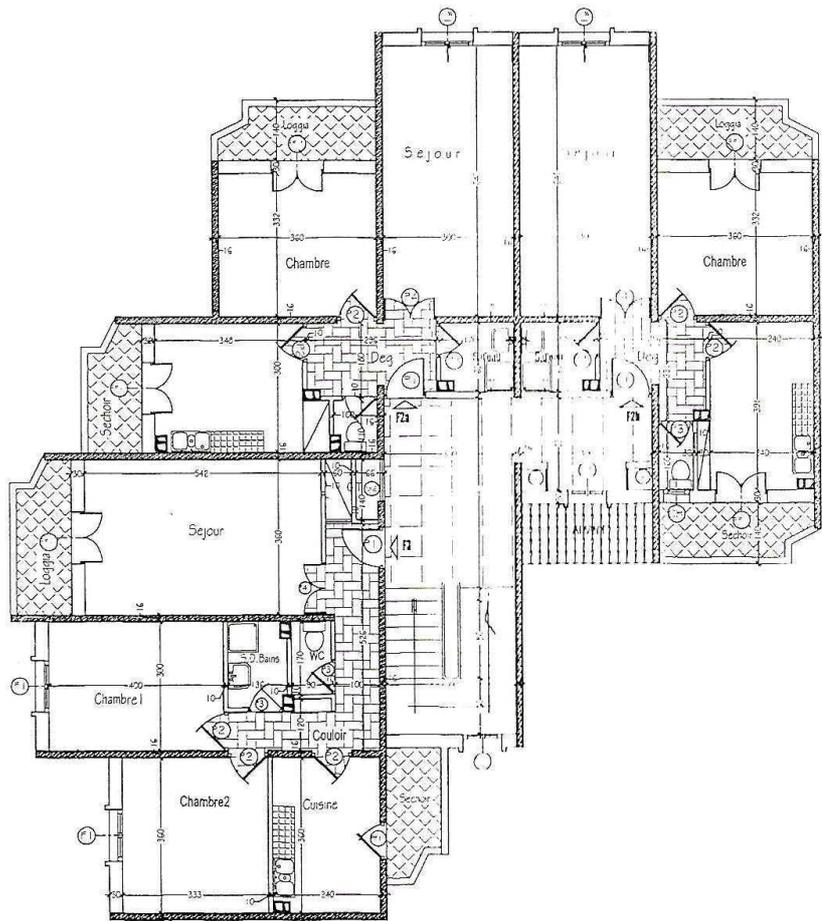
structure en murs porteurs préfabriqués - échelle : 1/150 -
